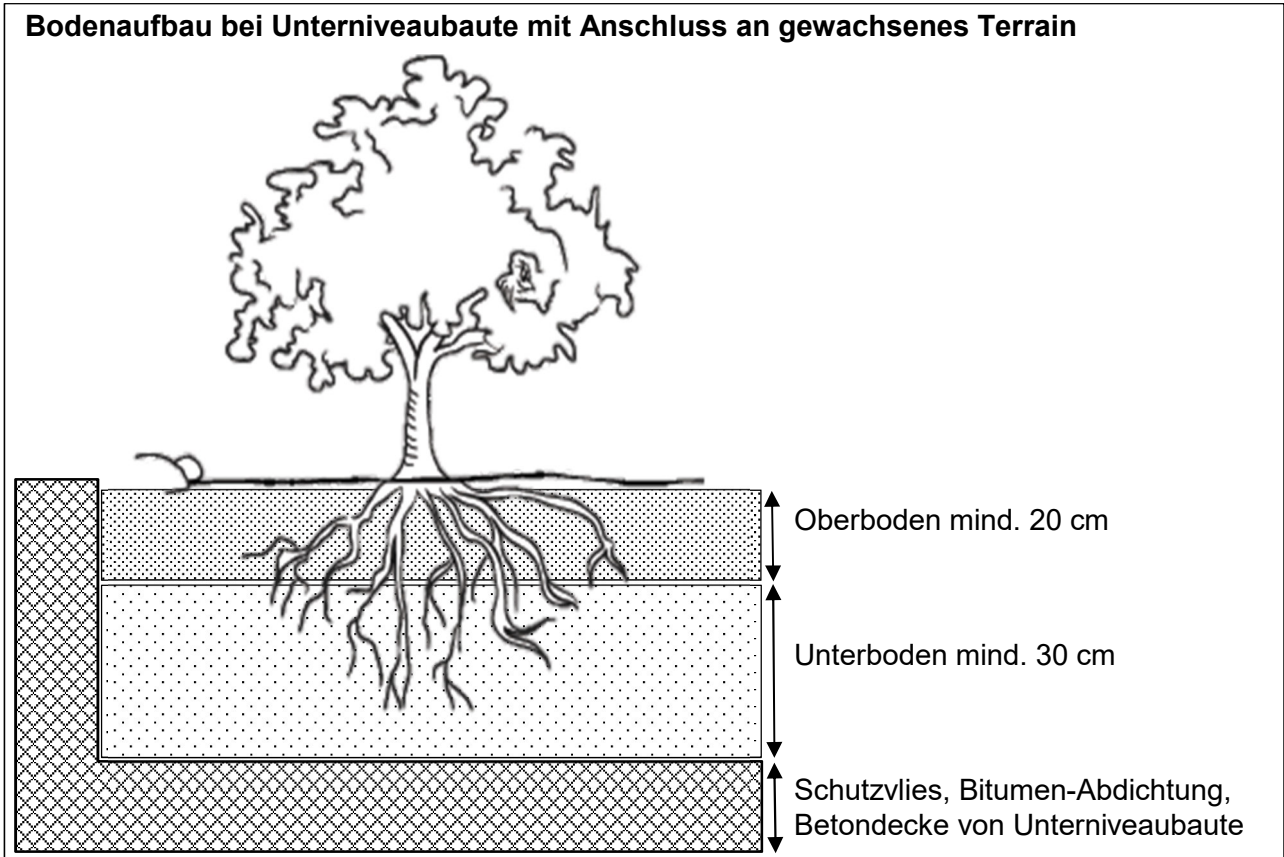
Bodenaufbau bei Unterniveaubaute
